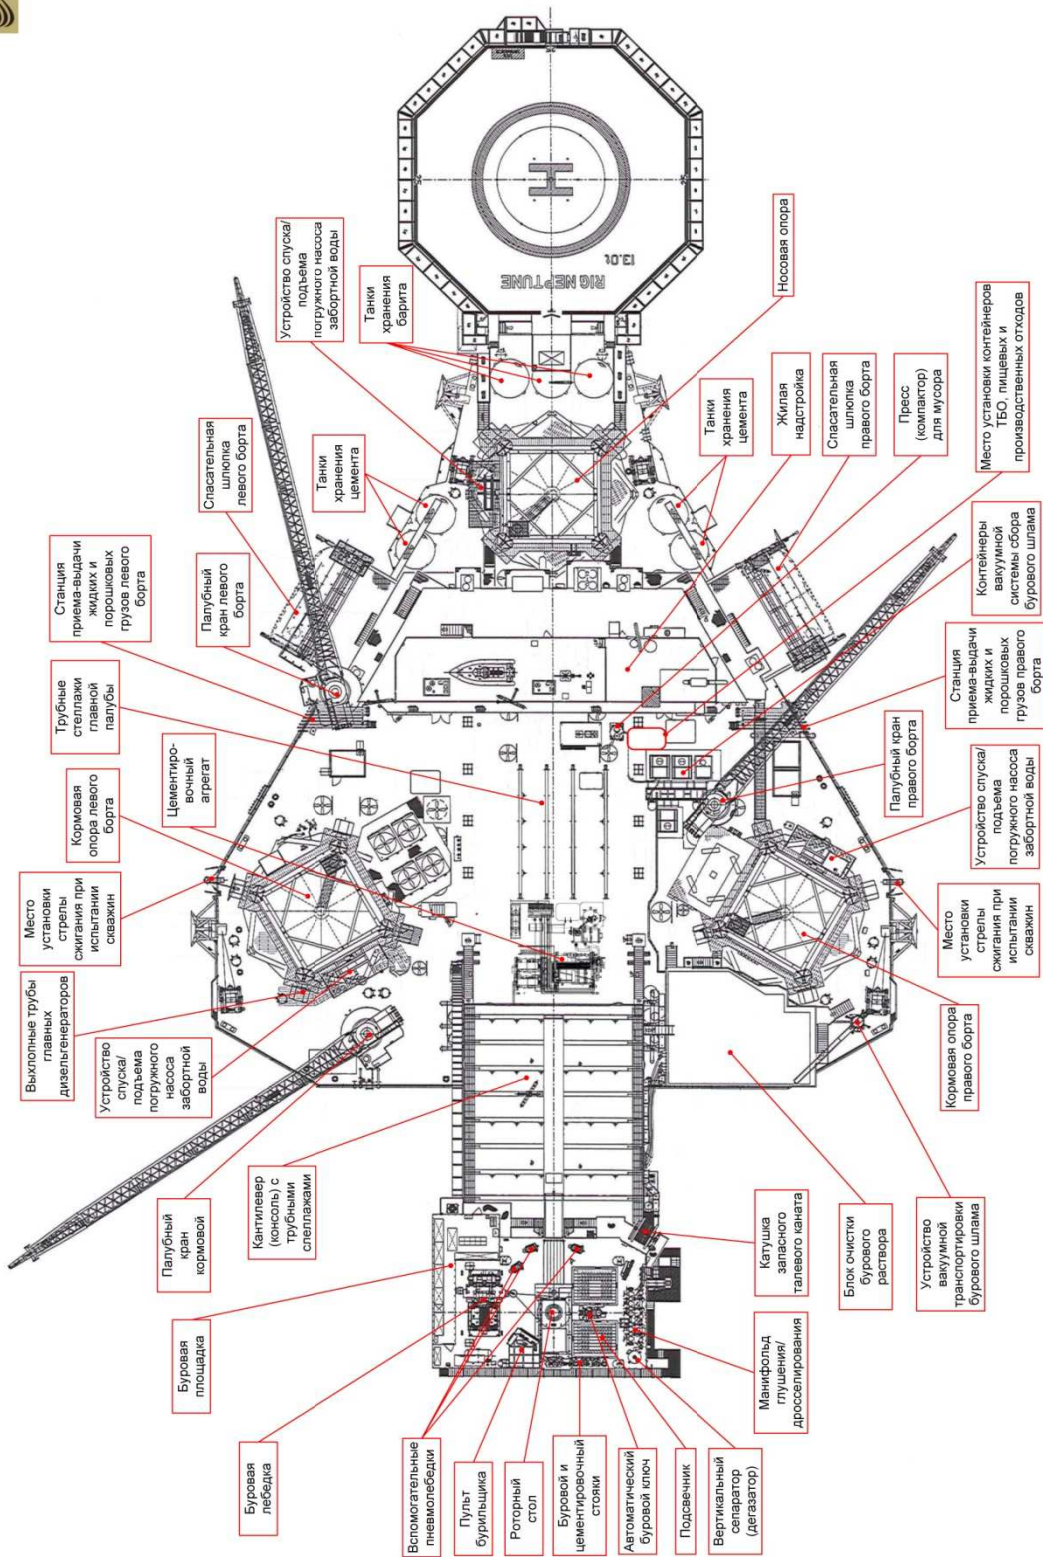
Схема общего расположения оборудования. Вид сверху
